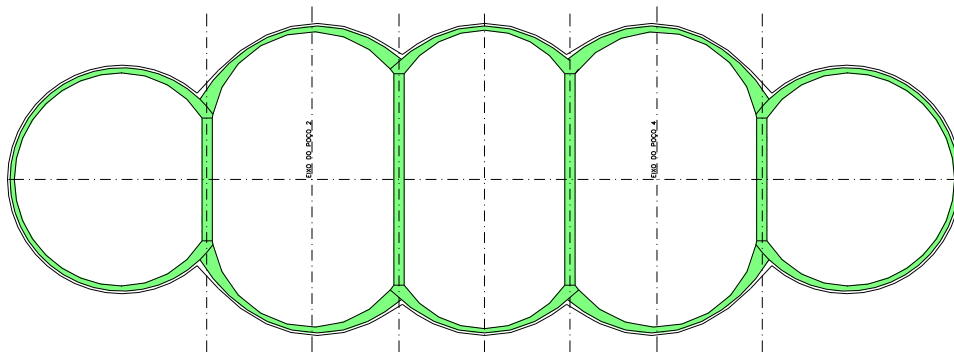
26 - Planta com execução do revestimento secundário no poço 2 e 4 (Adaptado CJC, 2008).
